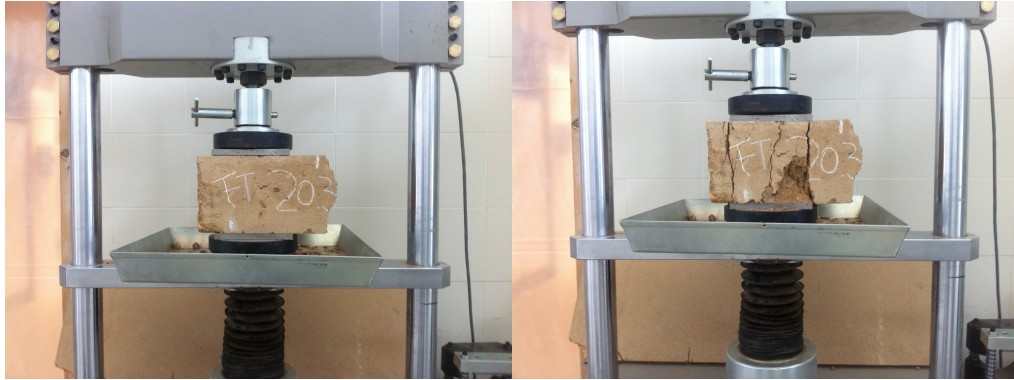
Colocación y rotura de probetas prismáticas ensayo compresión.
